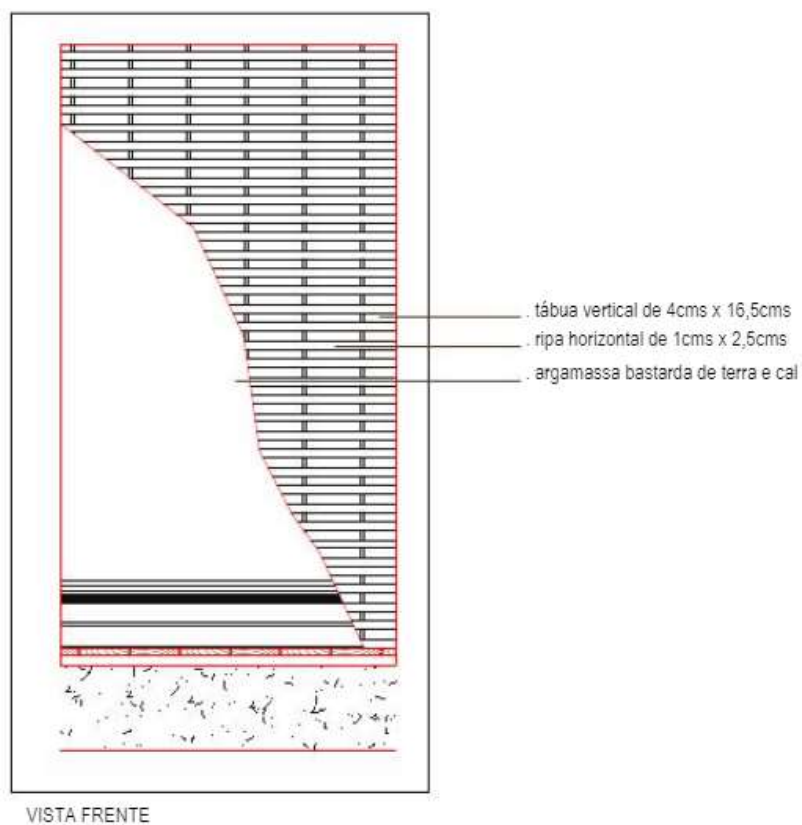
Desenho de Autocad parede tabique simples (vista de frente).
